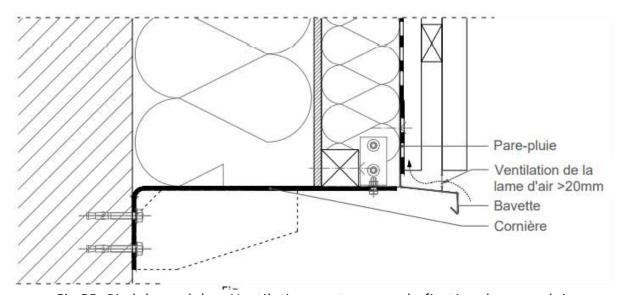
Pied de module – Ventilation par tasseaux de fixation du pare-pluie
